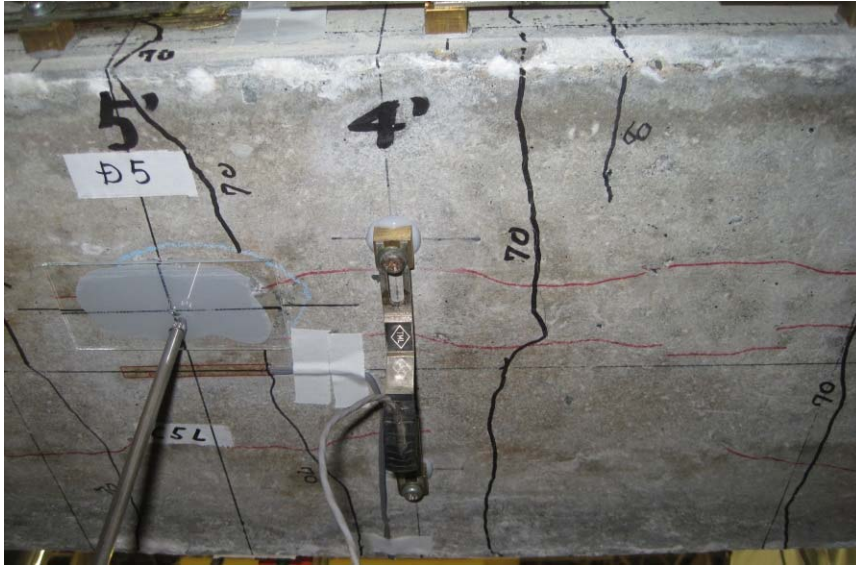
70kN 載荷時 G6 桁下面ひび割れ状況 (4'位置： PI-18)
